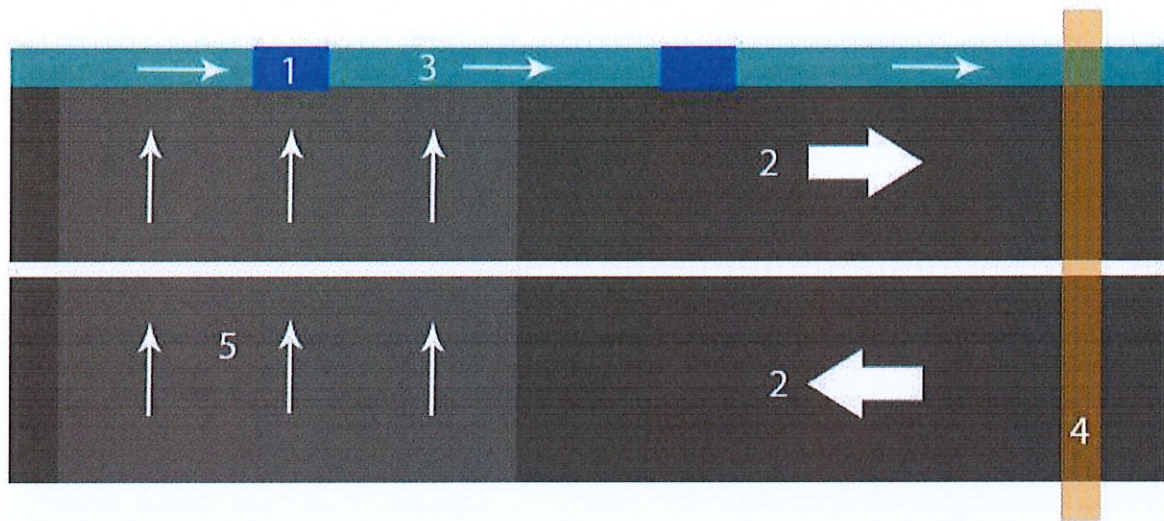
Skema e drenazhimit të sipërfaqes së trupit të rrugës
